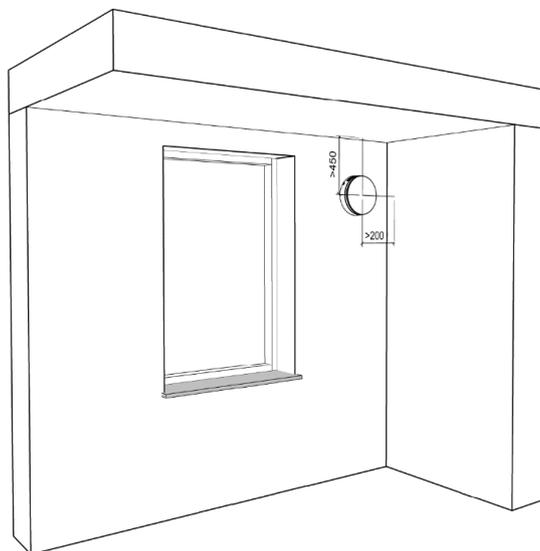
Distances minimales par rapport aux éléments de construction (en mm)
